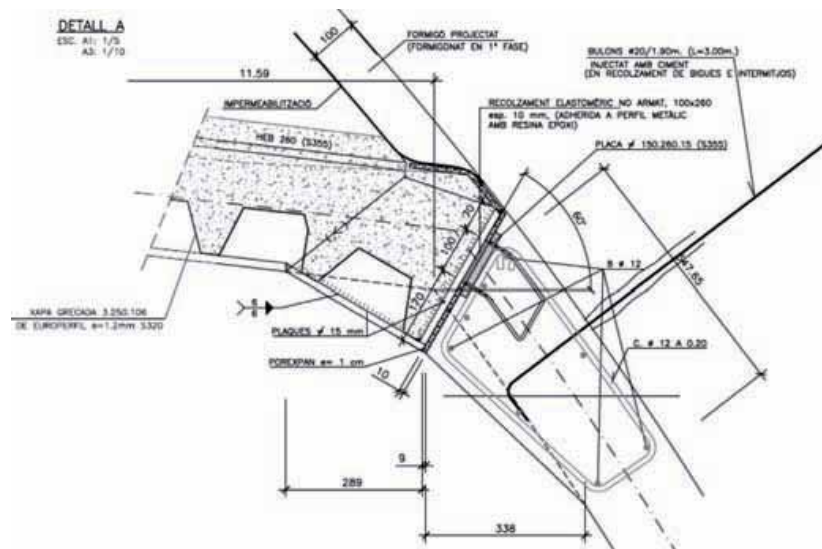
Detalle de la unión dintel-hastial del forjado mixto ligero.
